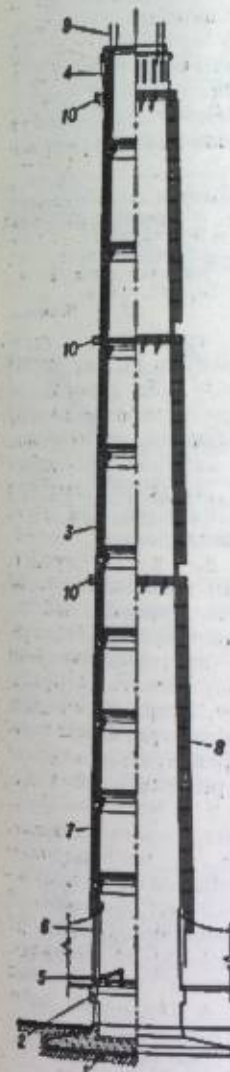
Коническая железобетонная труба высотой 120 м: 1 — фундамент; 2 — козырь; 3 — ствол; 4 — головов; 5 — вводы бортовых; 6 — футеровка; 7 — ходовая лестница; 8 — грозозащита; 9 — светофорные площадки.
